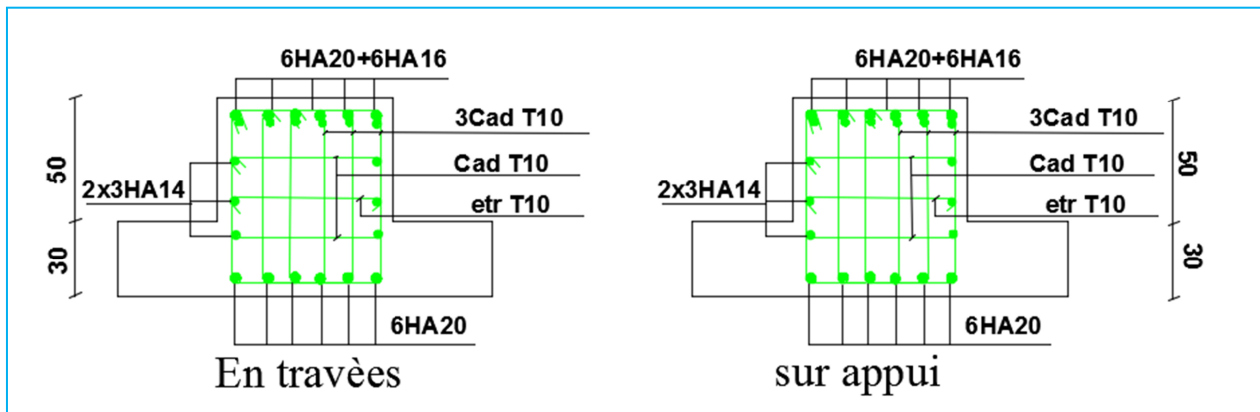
Schéma de ferrailage des nervures sens x-x
